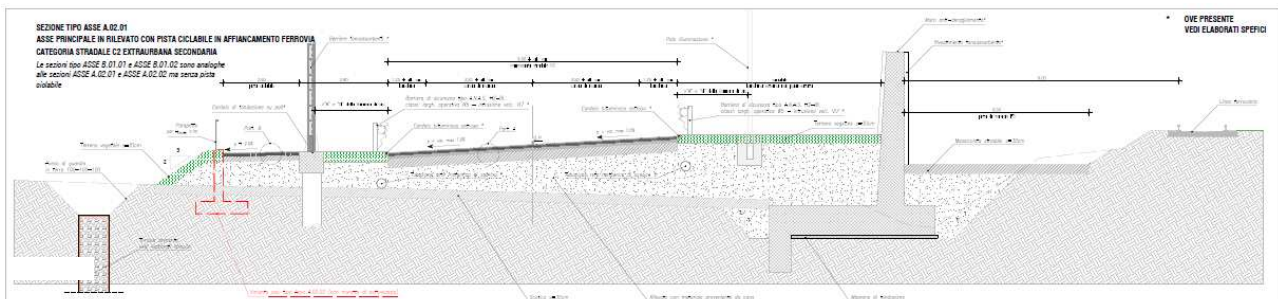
Sezione stradale tipologica Asse A ed Asse B tratto in affiancamento a ferrovia
